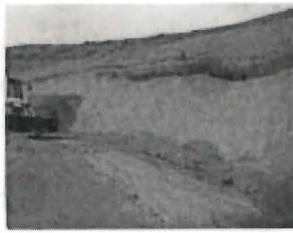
Vista Mirando hacia el Norte (revegetación actual)
